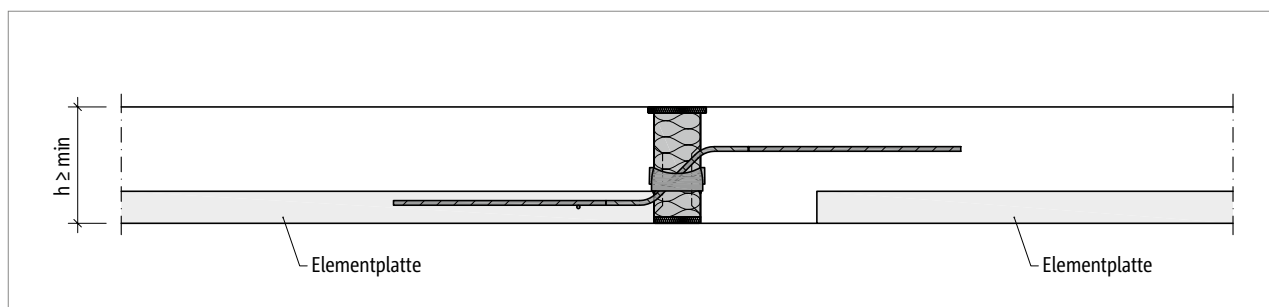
Schöck Isokorb® T Typ QL: Elementdecke mit eingesetzten Schöck Isokorb®
